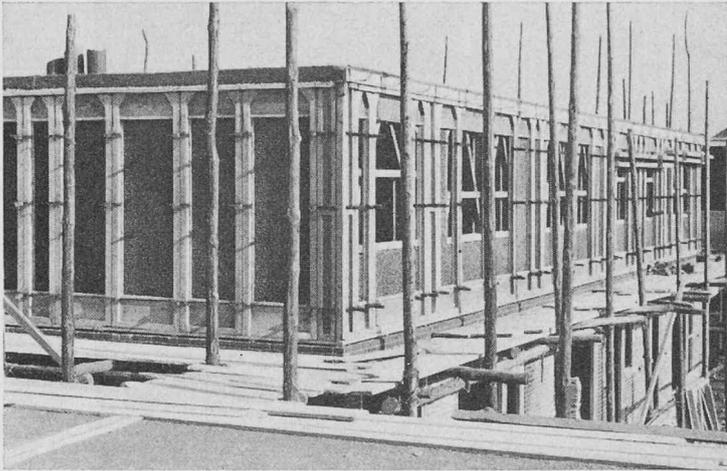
Construction monolithe « Korrelbeton » (Béton coffré). Un béton poreux est coulé dans des coffrages normalisés d'une hauteur égale à la hauteur d'étage et d'une largeur obéissant à un système modulaire de 10 cm.
